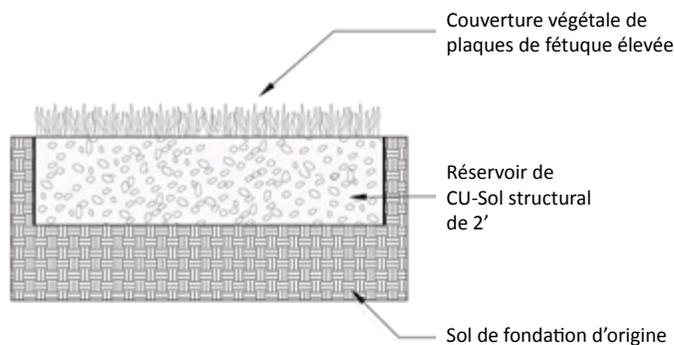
Coupe type d'un gazon renforcé de pelouse en plaque sur sol structural.
